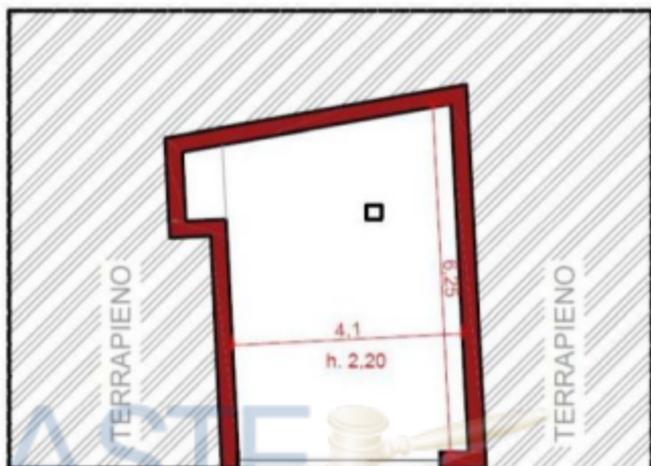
Planimetria dell'esistente rilevata in sede di sopralluogo
